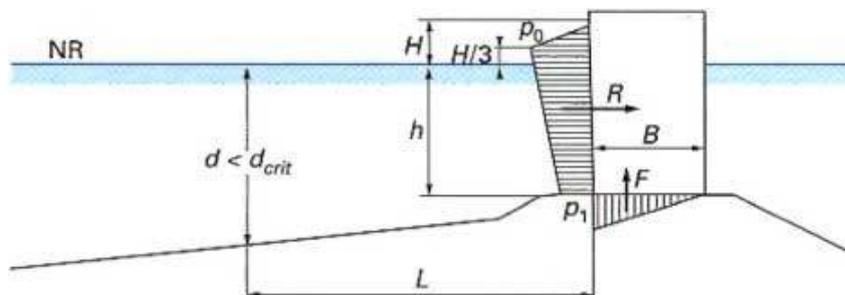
Surpressions dues à la houle sur une digue mixte en faible profondeur.
